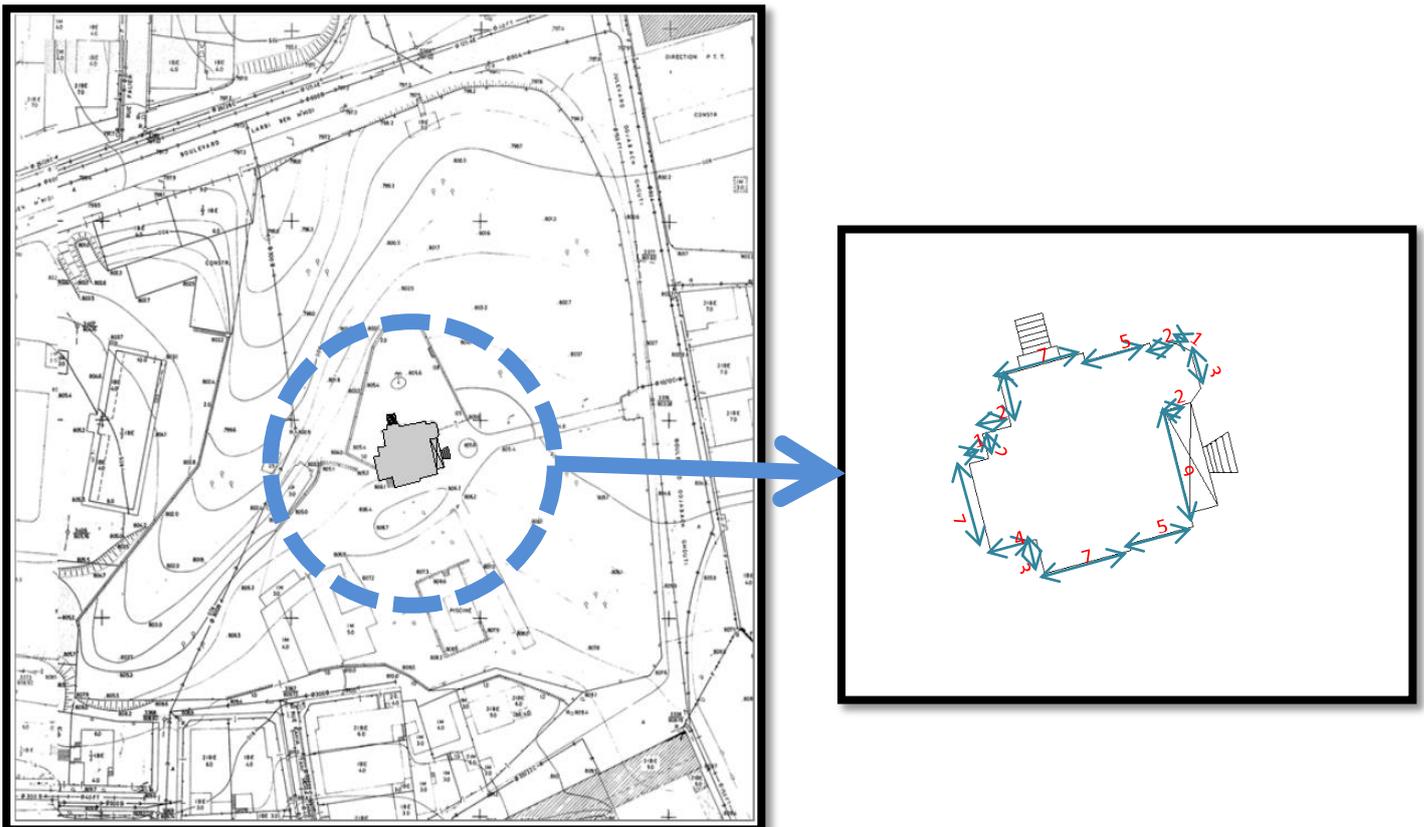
Plan de masse et relevé de la maison ABOU BAKR (Source : AUTEUR)
